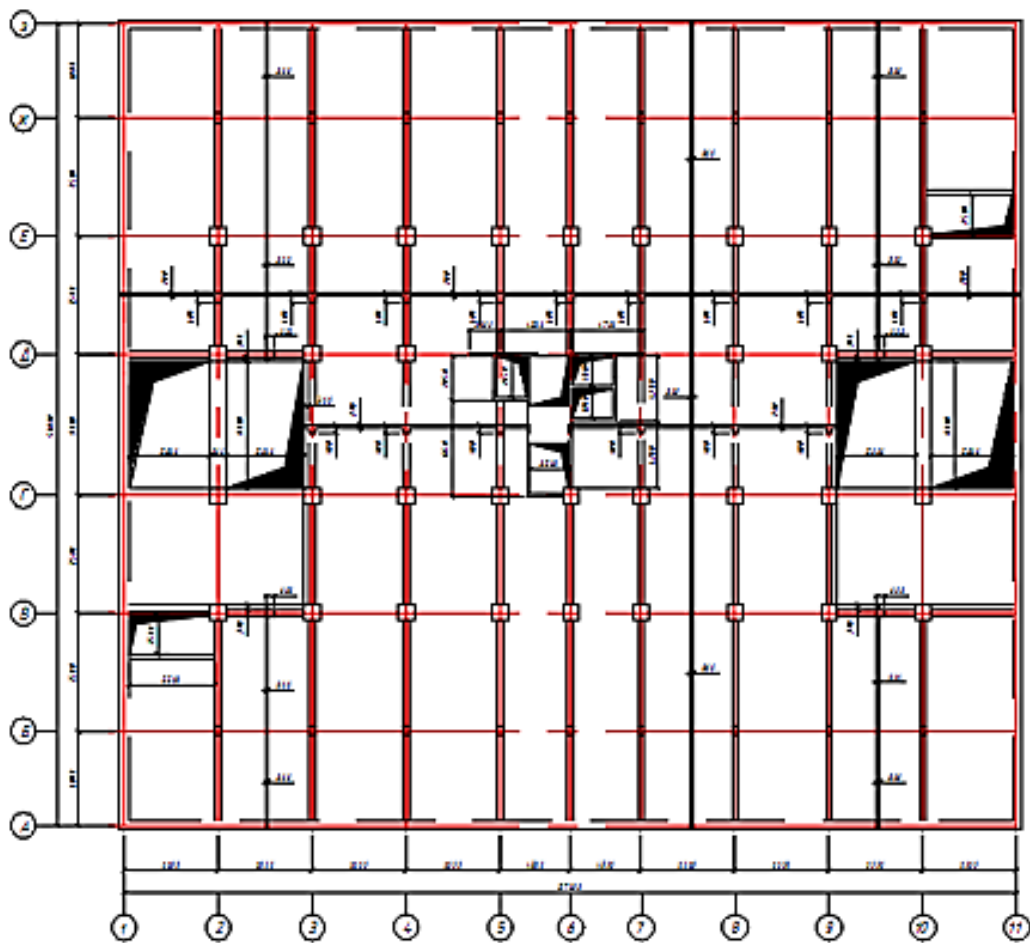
Монолітне перекриття на позначці -12,120 м
